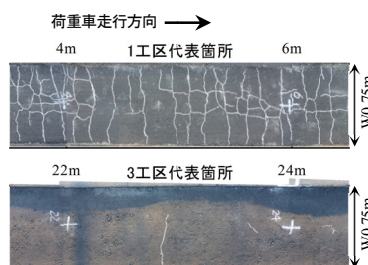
48,100輪時のひび割れ状況（上：1工区、下：3工区）
